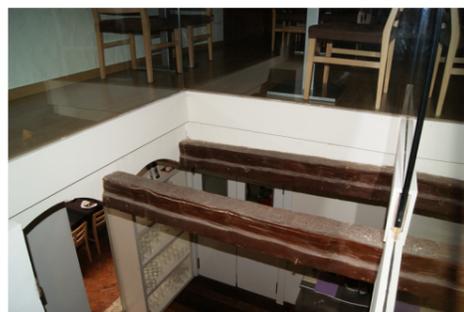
Vista del forjado revoltón del Restaurante 'El Túnel' (Xàtiva) después de su rehabilitación. Fuente: Propio autor.
